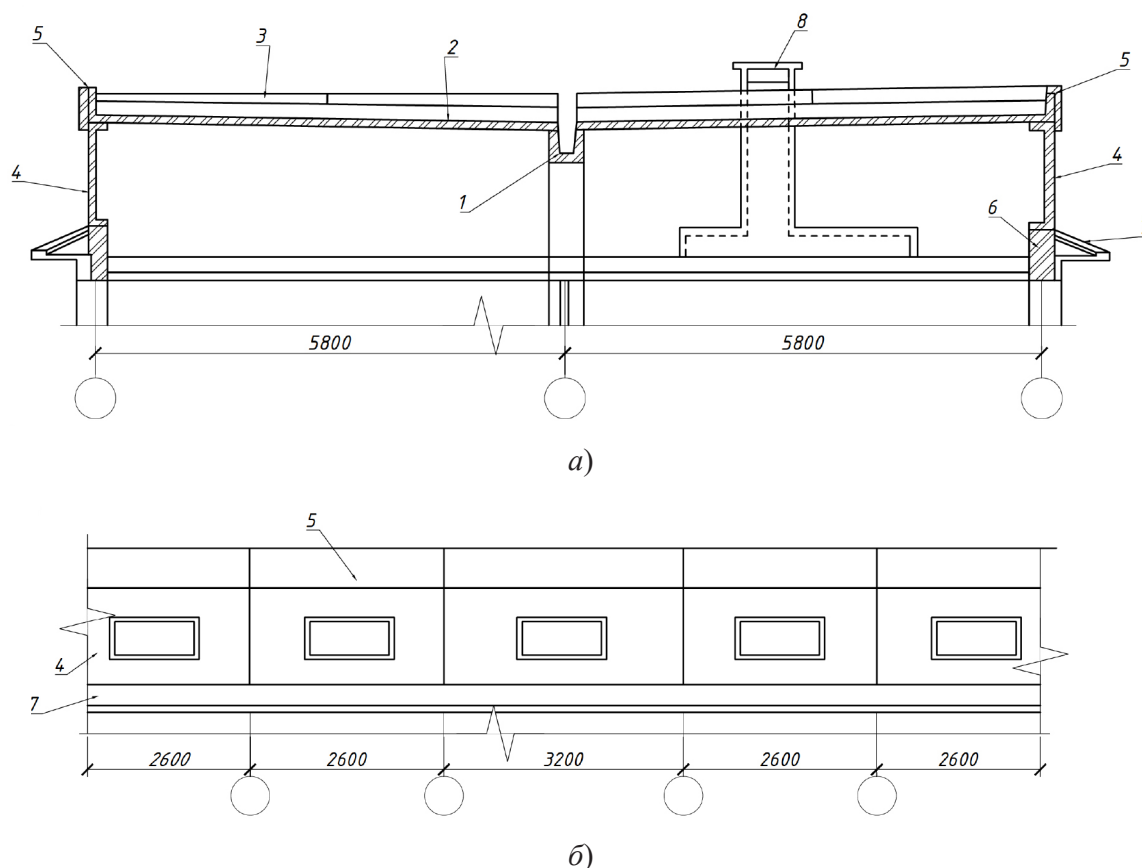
Устройство чердачной крыши из лотковых элементов: 1 – центральный сборный прогон-лоток; 2 – кровельный лоток; 3 – нащельник лотковый; 4 – панель ограждения чердака; 5 – элемент фронтона; 6 – кирпичная кладка; 7 – кровля из оцинкованной стали; 8 – вентиляционная шахта
